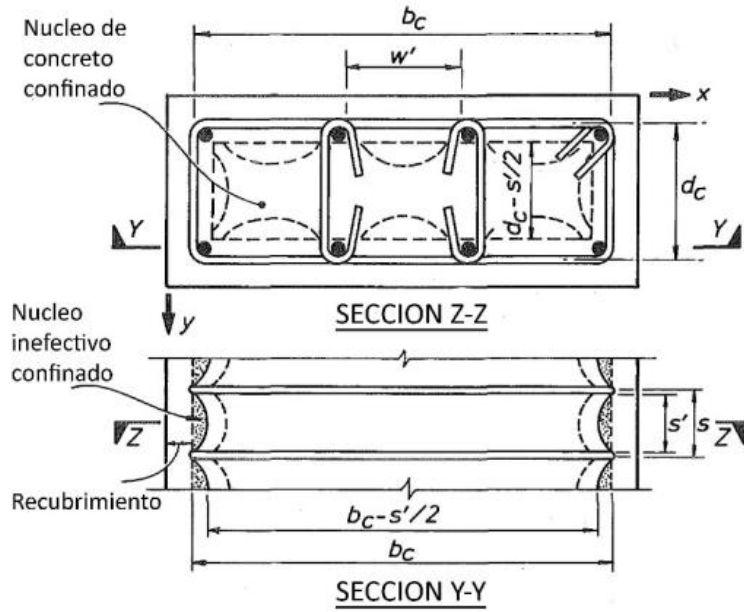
Núcleo de concreto confinado para estribos rectangulares (Mander, Priestley, & Prack, 1988)
